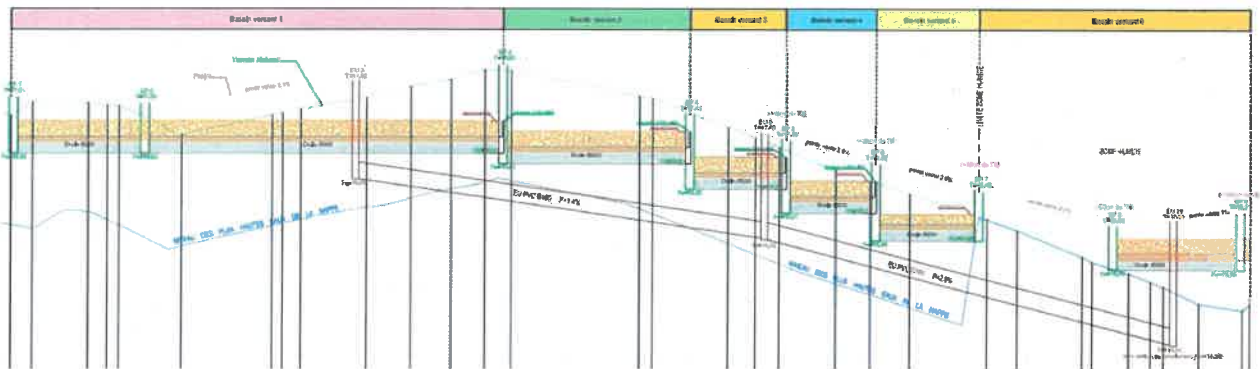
Plan en coupe du système d'assainissement des eaux pluviales
